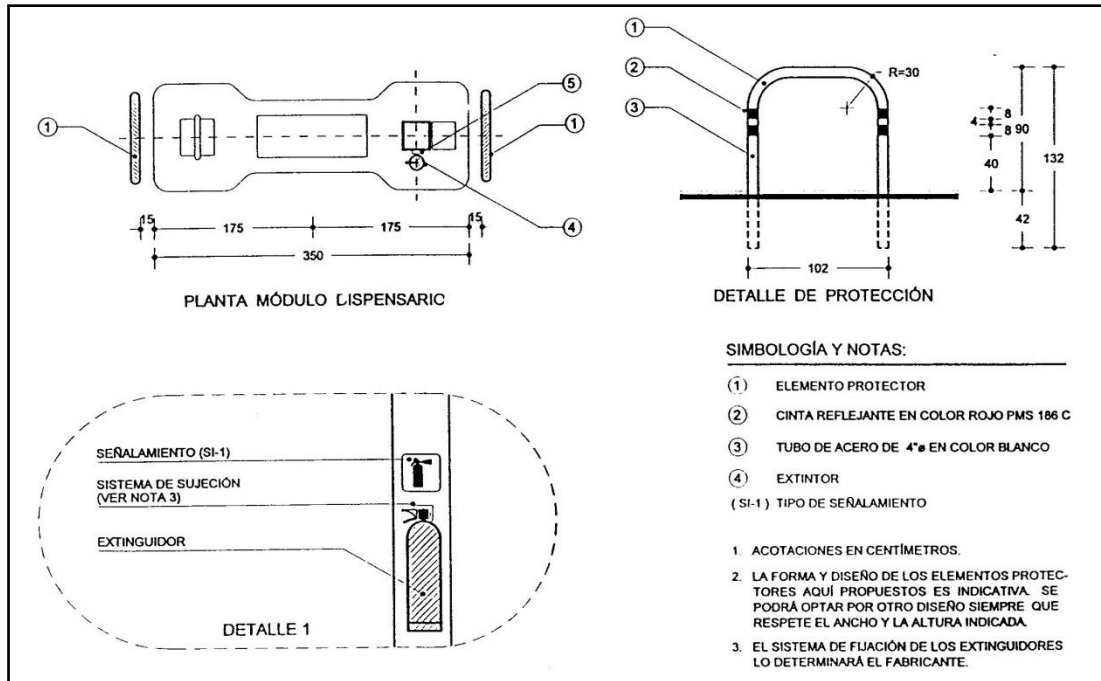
Detalles de Protección y Planta Módulo Dispensarios.
